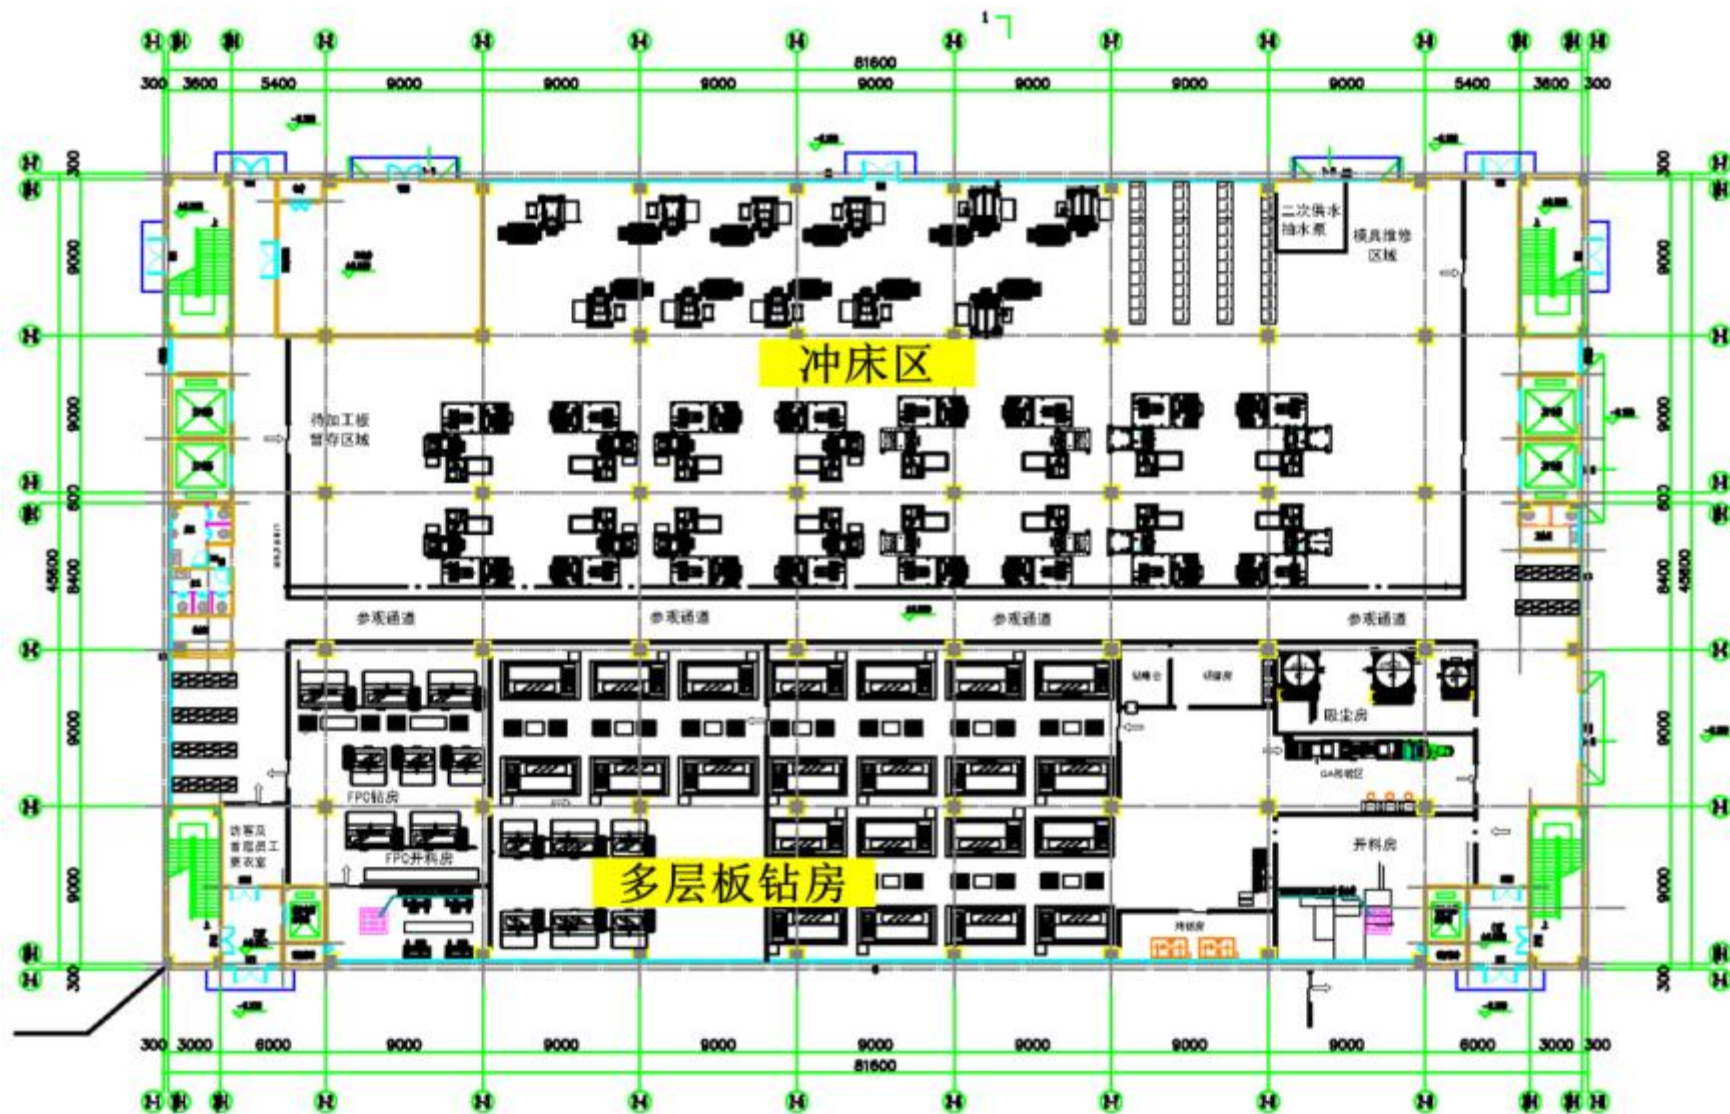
本项目二号厂房 1 楼环评阶段平面布置图
